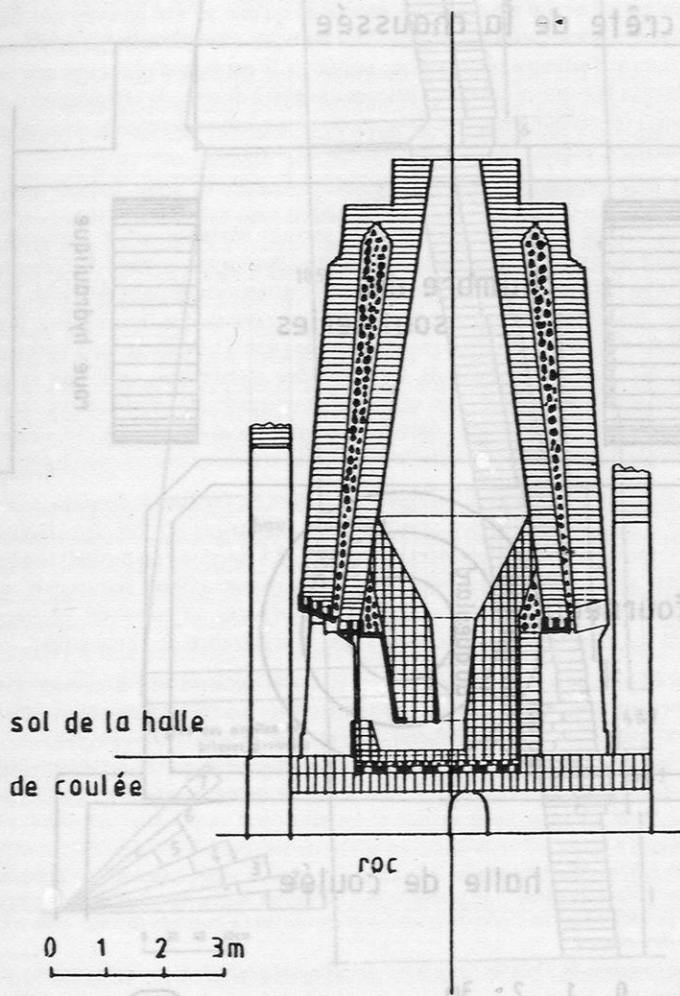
Haut fourneau des Salles (1858-59) : coupe.
